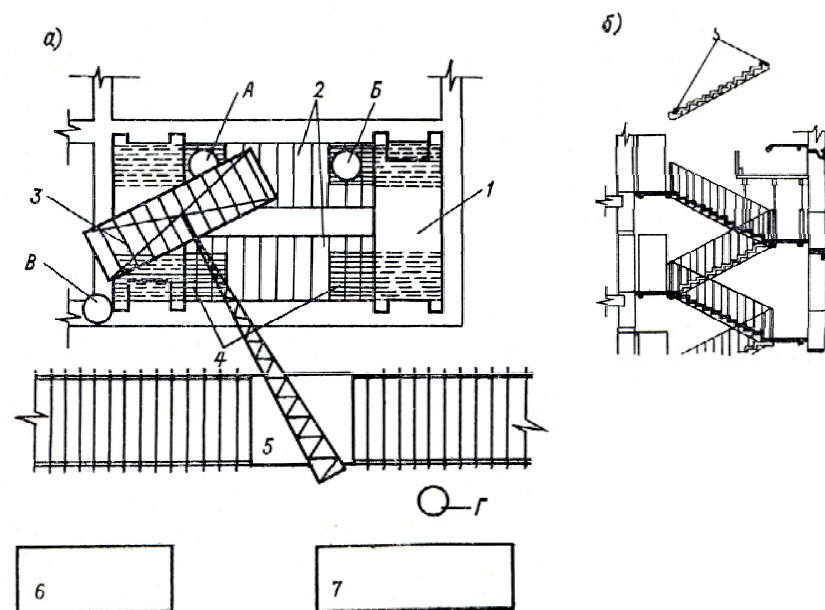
Схема организации работ: а – план; б – разрез; 1 – уложенные лестничные площадки; 2 – ранее уложенные лестничные марши; 3 – монтируемый лестничный марш; 4 – подмости; 5 – башенный кран; 6 – складирование лестничных площадок; 7 – место складирования лестничных маршей; А, Б, В, Г – рабочие места монтажников
